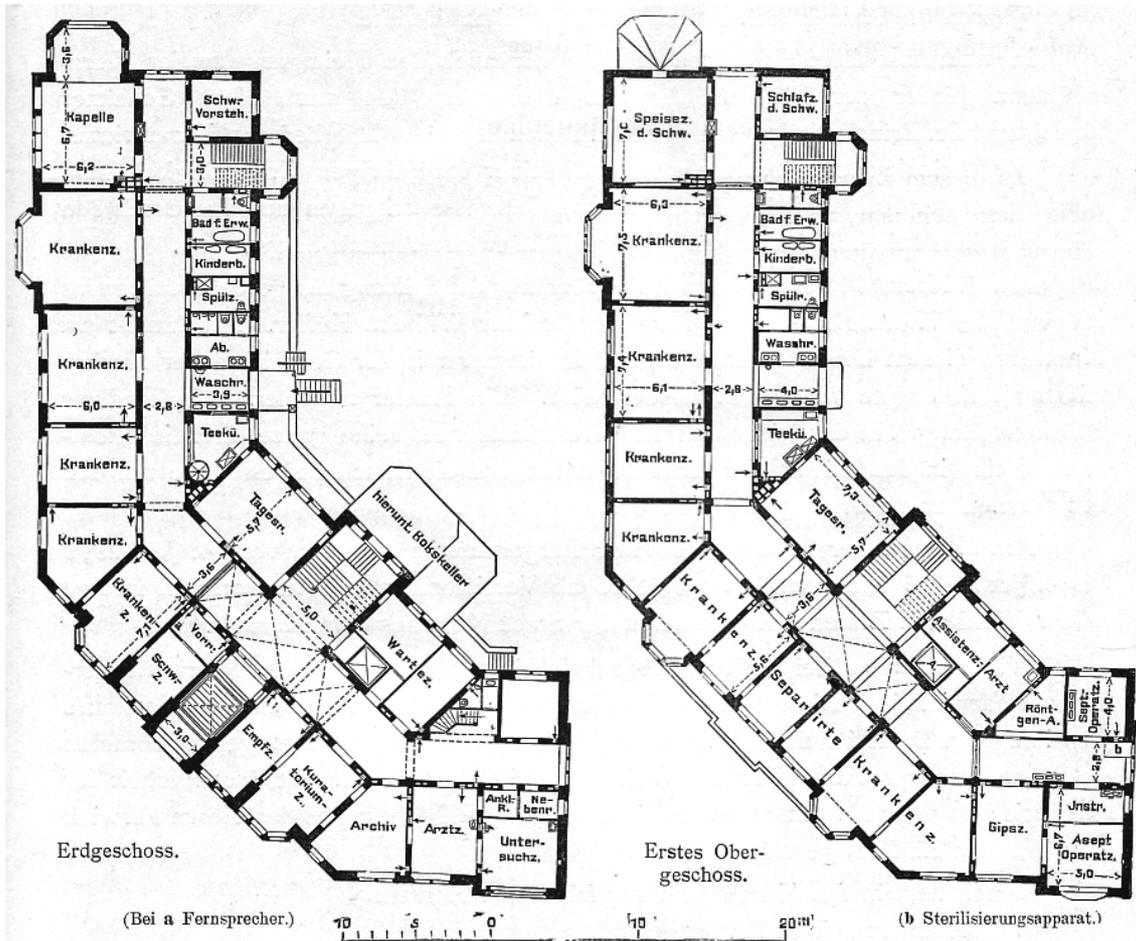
Grundrisse zweier Stockwerke der Hüferstiftung
